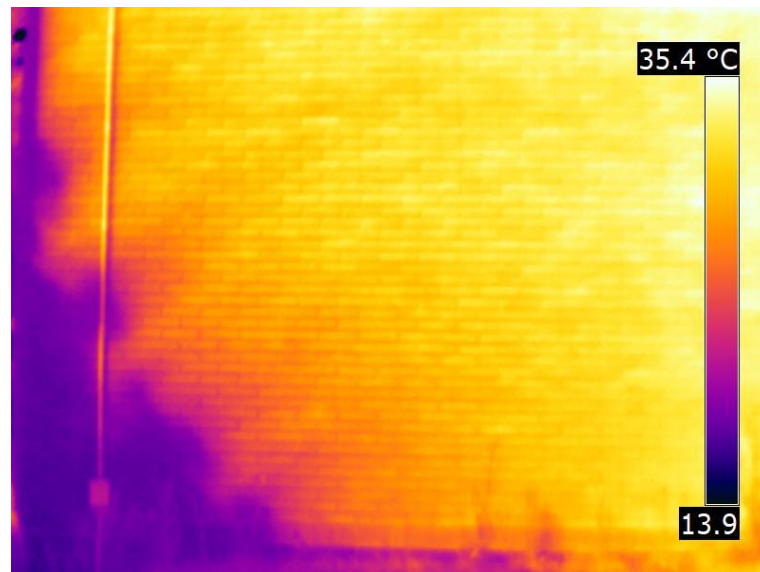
Termograma com pouca nitidez retirado da fachada de tijolo aparente do RU (sul)
